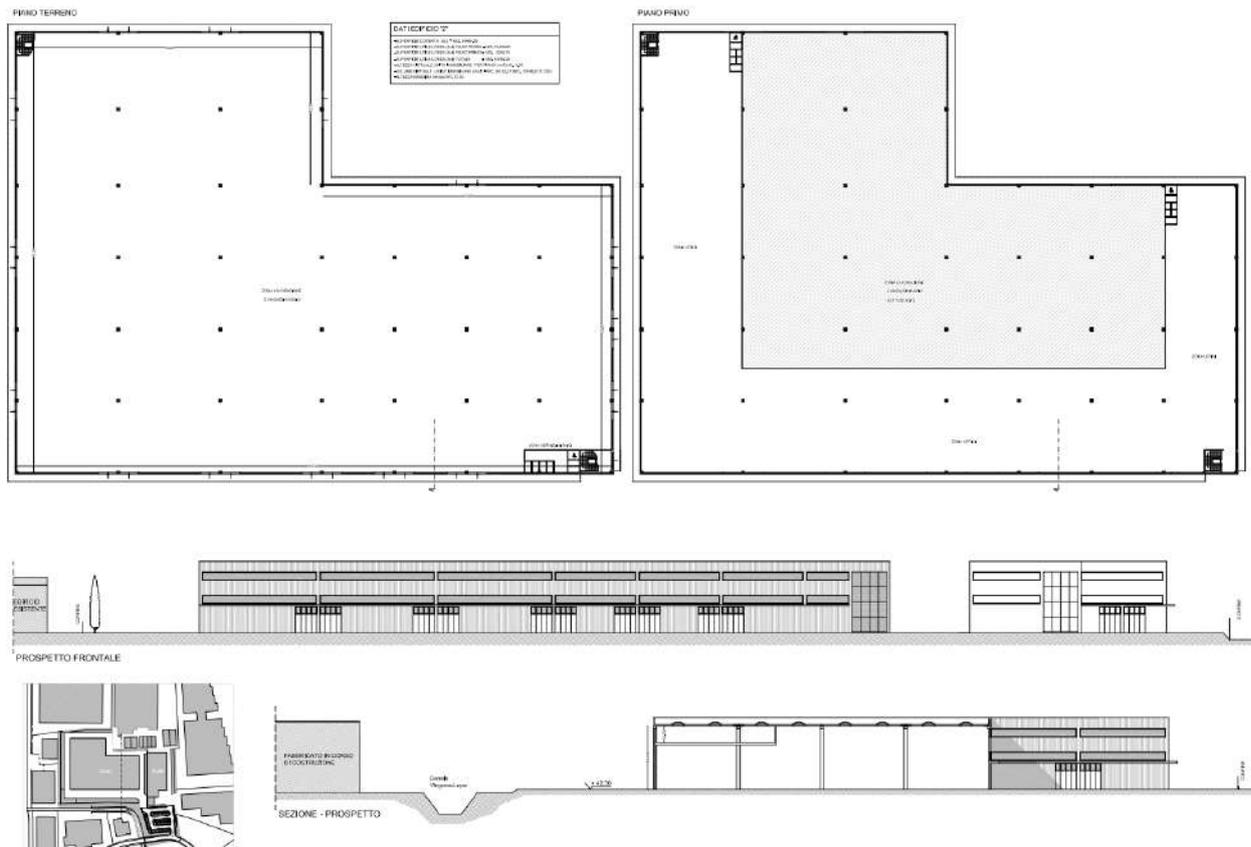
Pianta, sezione e prospetto Lotto 2 (Fonte: Tav. E8 Lotto 2 del Piano Attuativo PMU 4.4)
